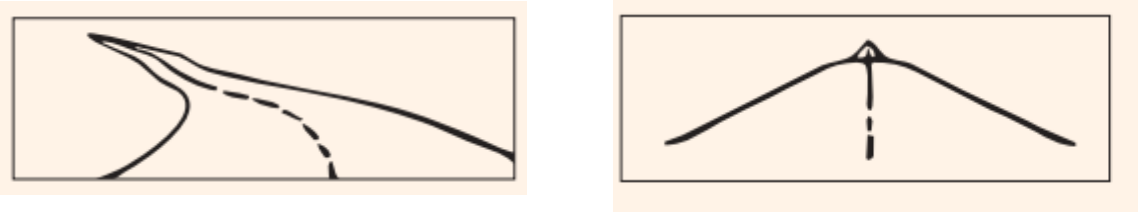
Situaciones a evitar en la coordinación planta alzado
